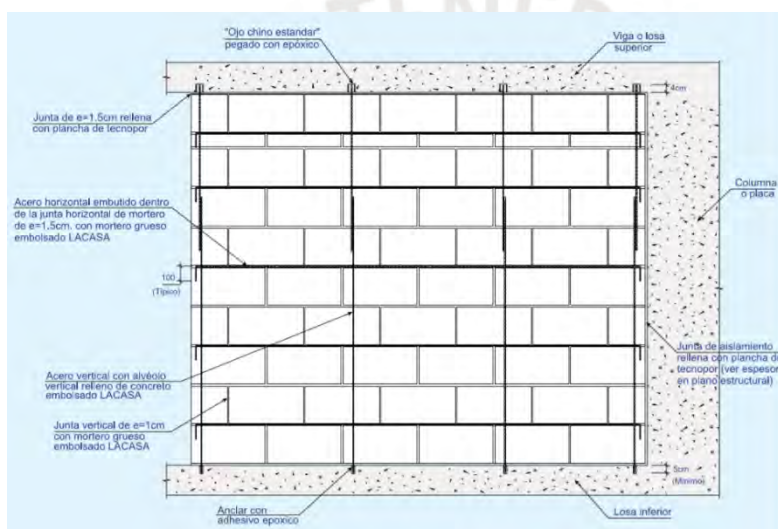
VISTA DEL ACERO EN UN TABIQUE AISLADO.
